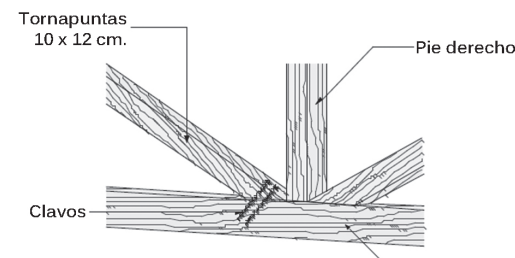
Detalle de ensamblaje de tornapuntas con clavos.
